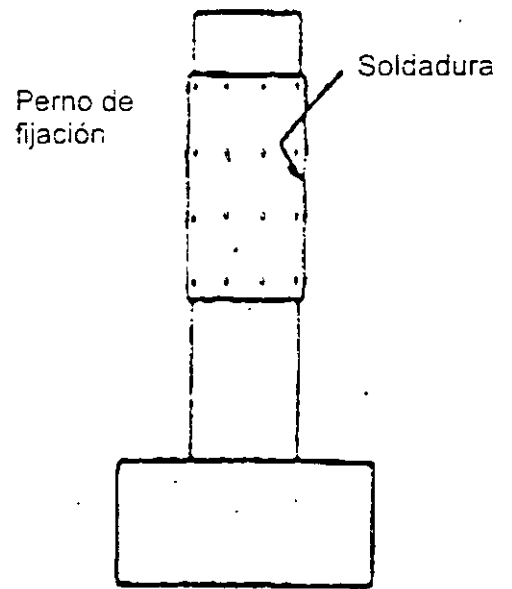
REFORZAMIENTO DE PILAS DE CONCRETO EN ZONAS DONDE SE CORTA EL ACERO DE REFUERZO PRINCIPAL
